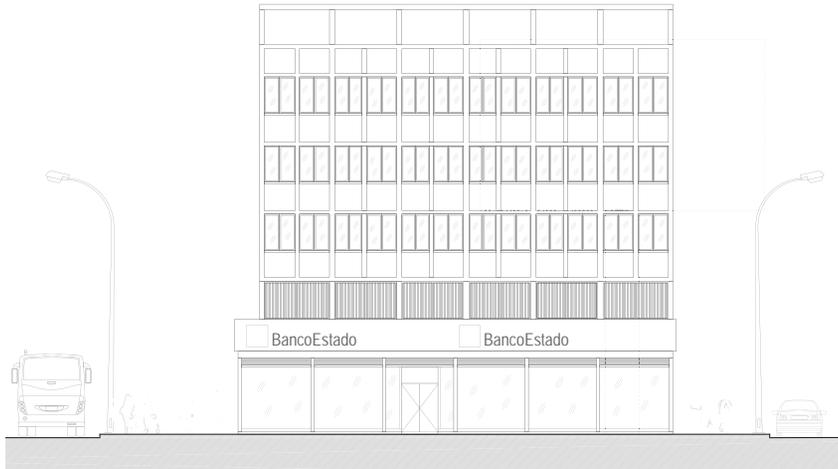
Elevación de fachada Oriente (Esquina Crucero Alameda-Ecuador) del terreno. Fuente: Elaboración propia.
